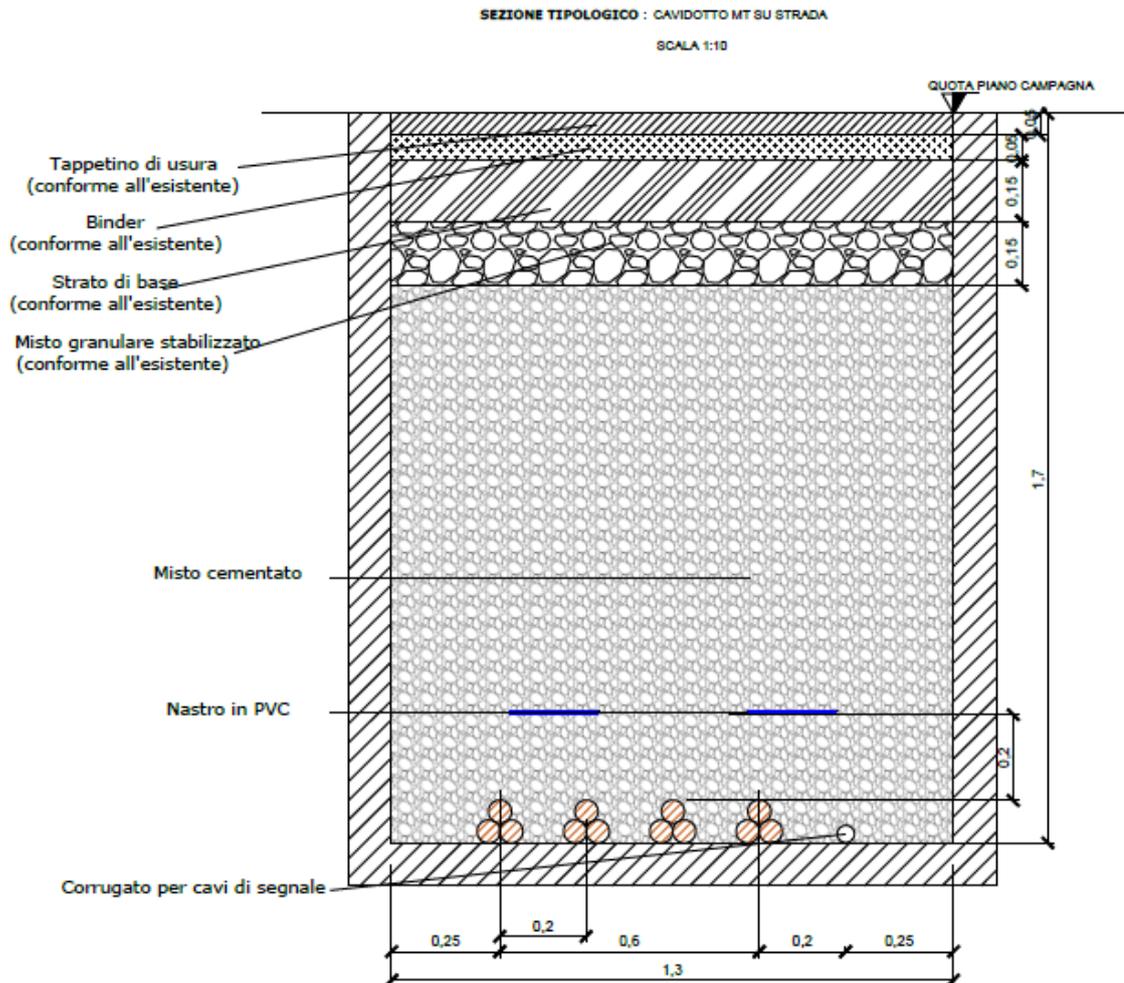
Sezione tipo posa con cavi direttamente interrati su strada
